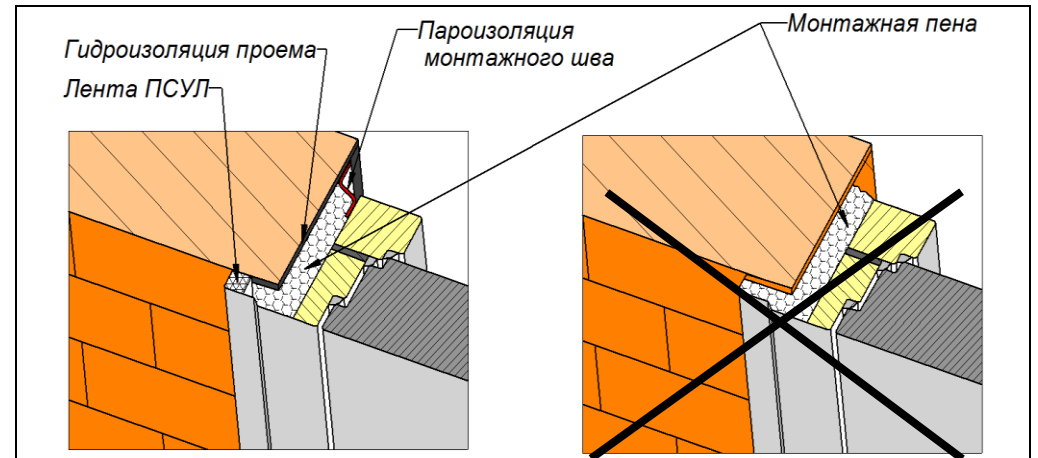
Схема ПРАВИЛЬНОГО монтажа дверного блока в проем кирпичного дома (Выполнена гидроизоляция проема, наклеена лента ПСУЛ по периметру наличника, выполнена пароизоляция монтажного шва)
